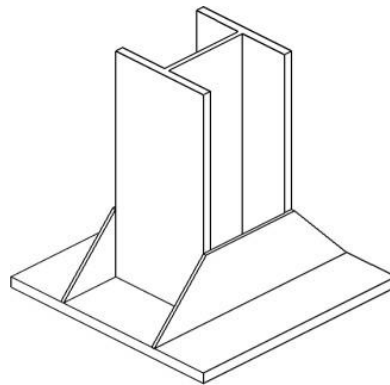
Vista 3D de la placade anclaje de los pilares de la ENTREPLANTA.
